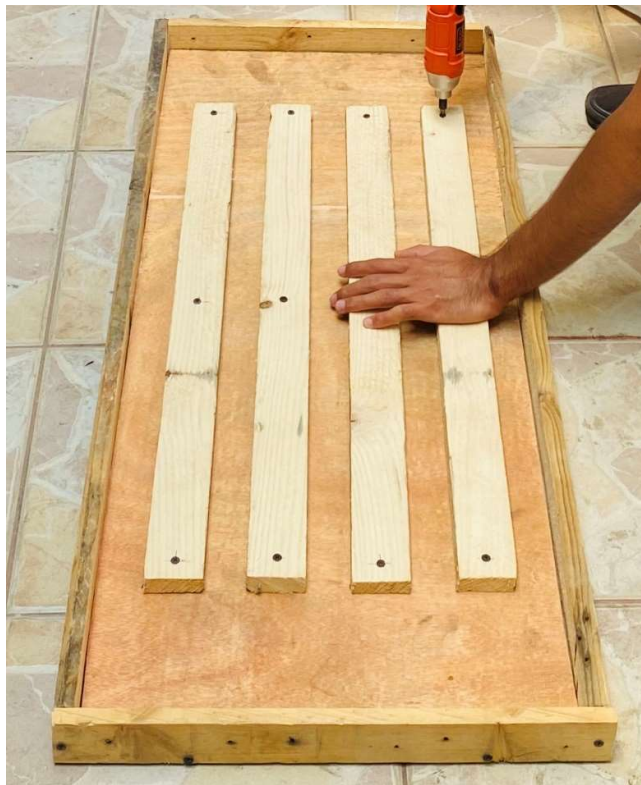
Construcción de encofrado para plancha ultraliviana - Parte 4.
